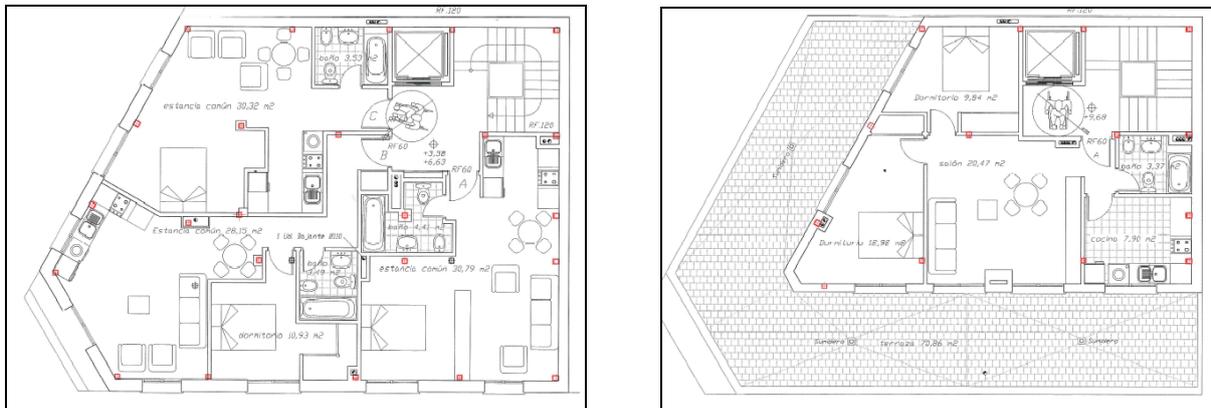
y 5. Planta primera y segunda (izquierda) y planta ático (derecha)
